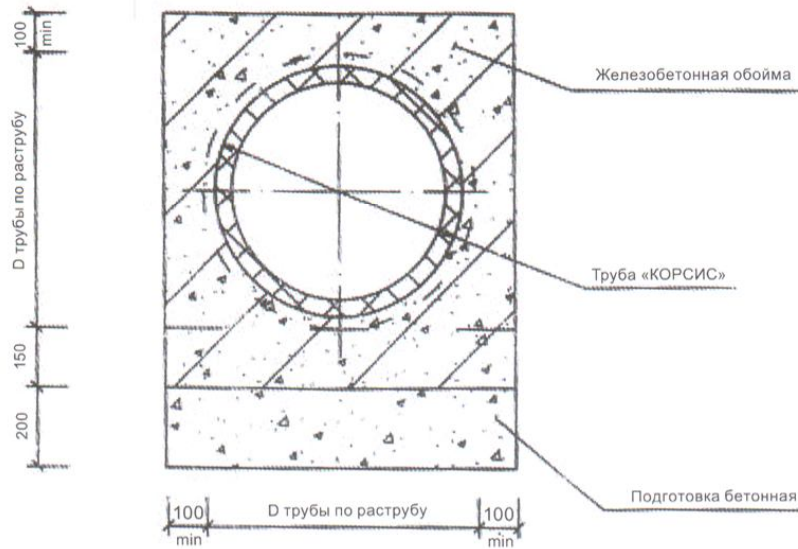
Конструкция железобетонной обоймы на трубах «КОРСИС»
